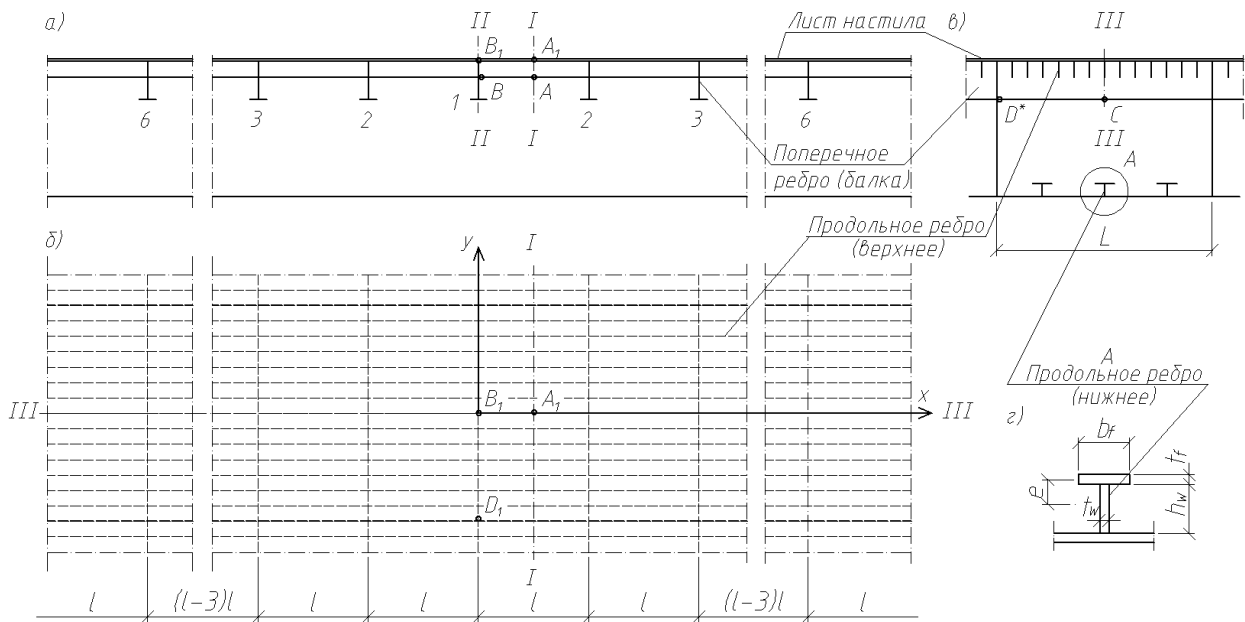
Схема к расчету ортотропной плиты [87]
